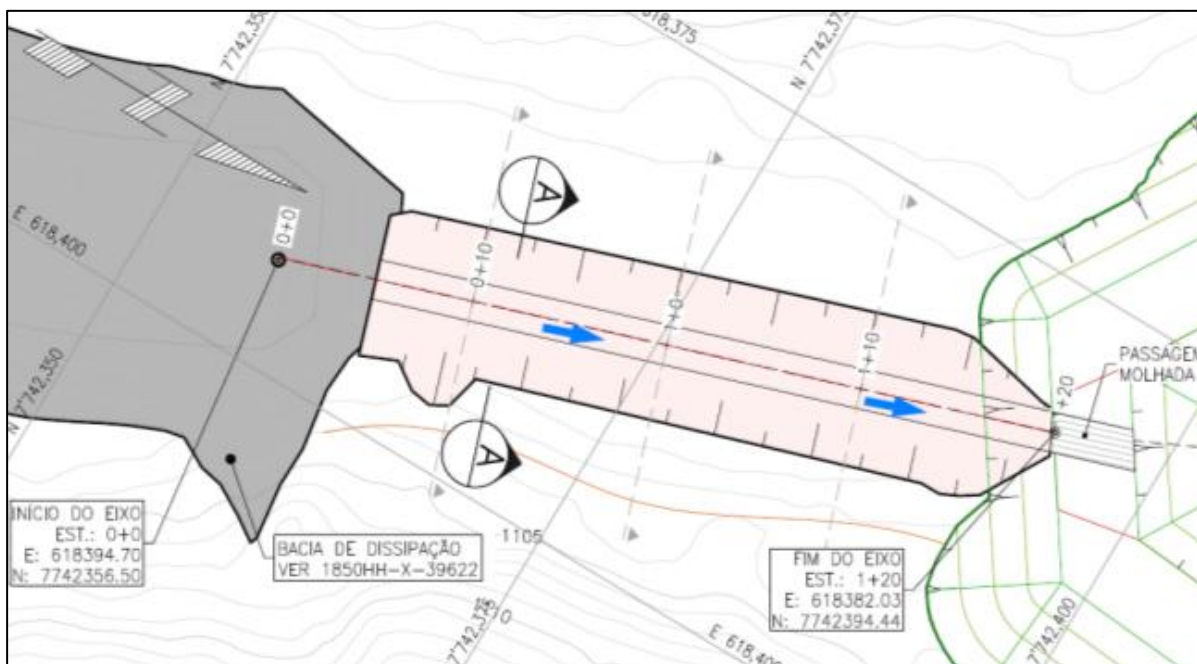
Vista em planta do canal afluente. Fonte: 1850HH-X-39804.
